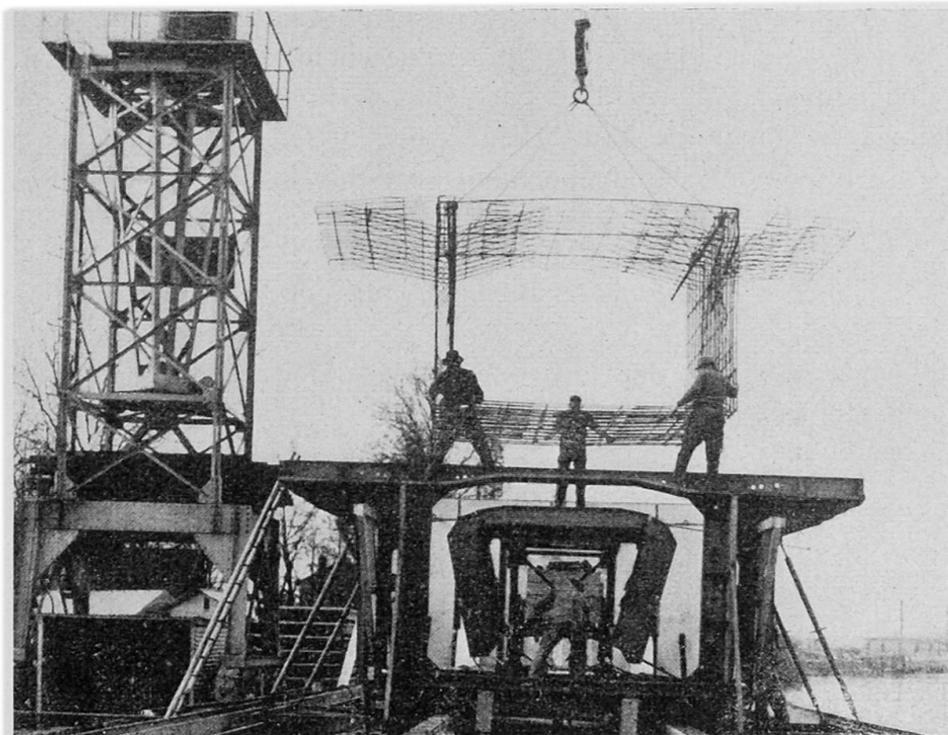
Pont de Choisy-le-Roi. Mise en place d'un ferrailage de voussoir préfabriqué (Campenon - Bernard).
